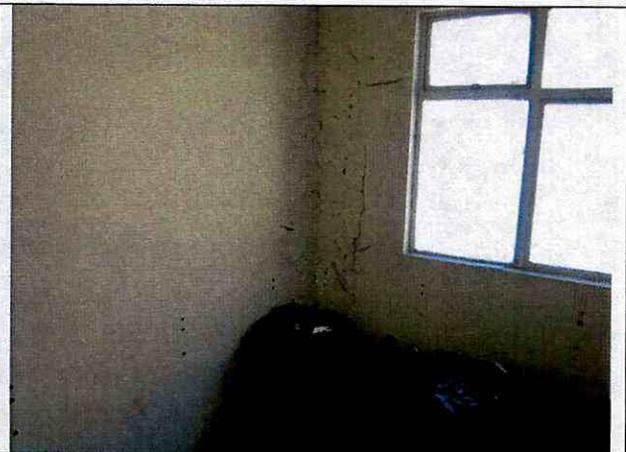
Fisuras y deterioro en muros de altillo.
